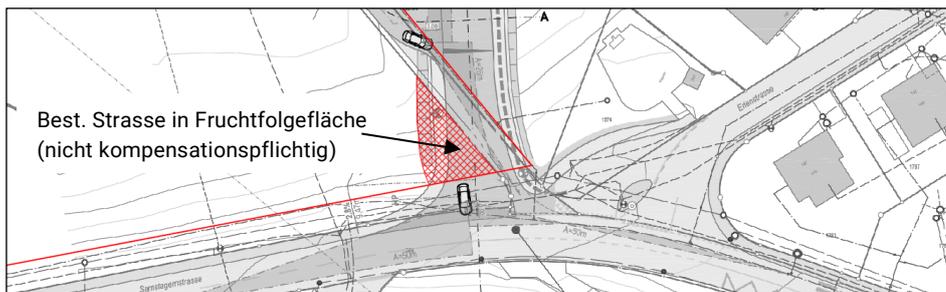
Betroffene Fruchtfolgefläche, Quelle Hintergrund: Machbarkeitsstudie Junkerstrasse, dat. 09.08.2024
